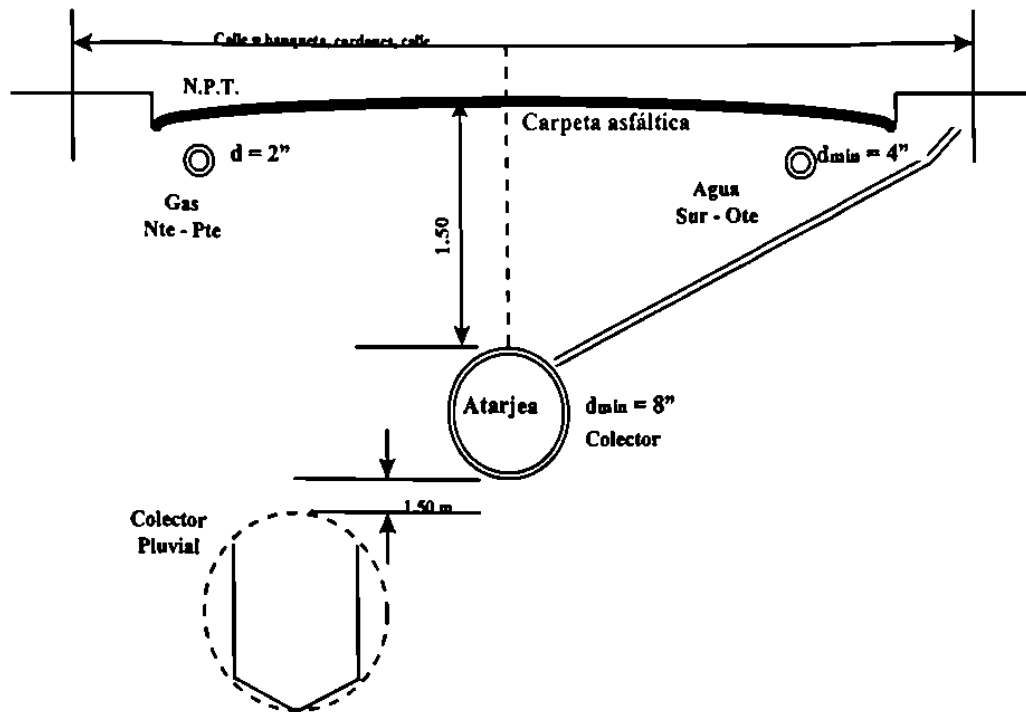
Corte típico de localización de una tubería de la red de alcantarillado
